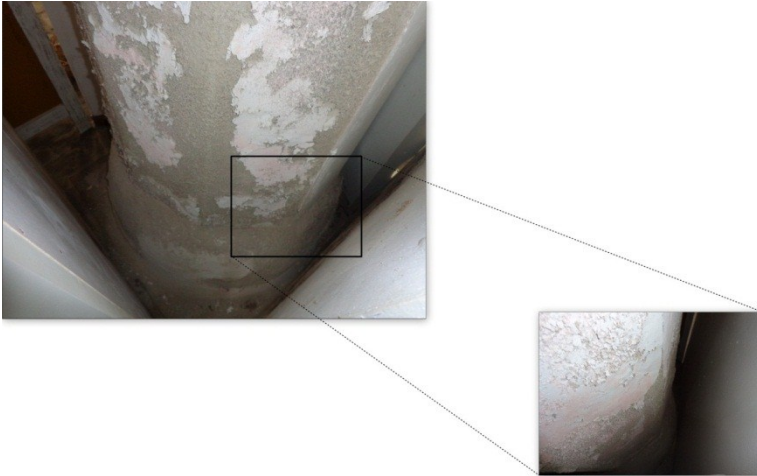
Pulverulência da argamassa - Pilar central, ala oeste
